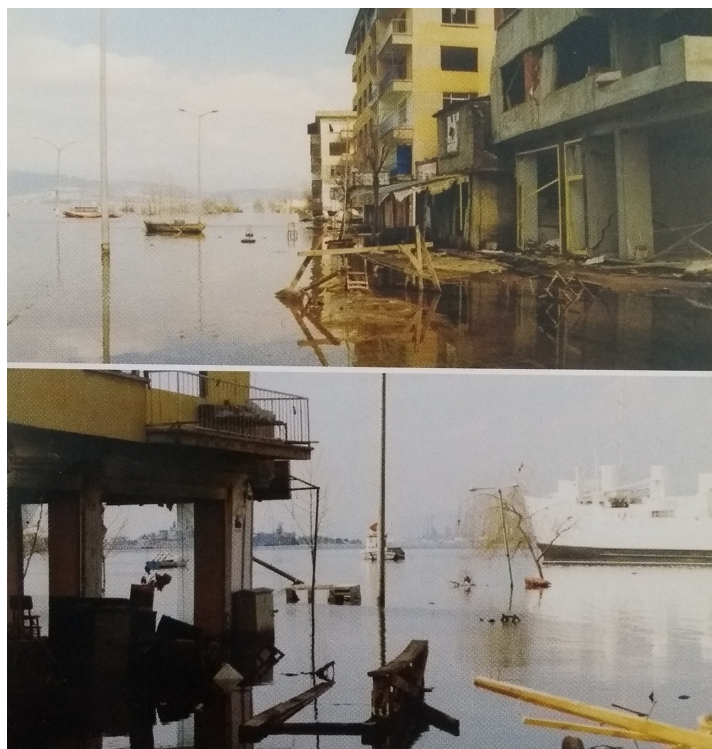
Fenómeno de abatimento e compactação. Abatimento de origem tectónica (Lopes, 2008).
